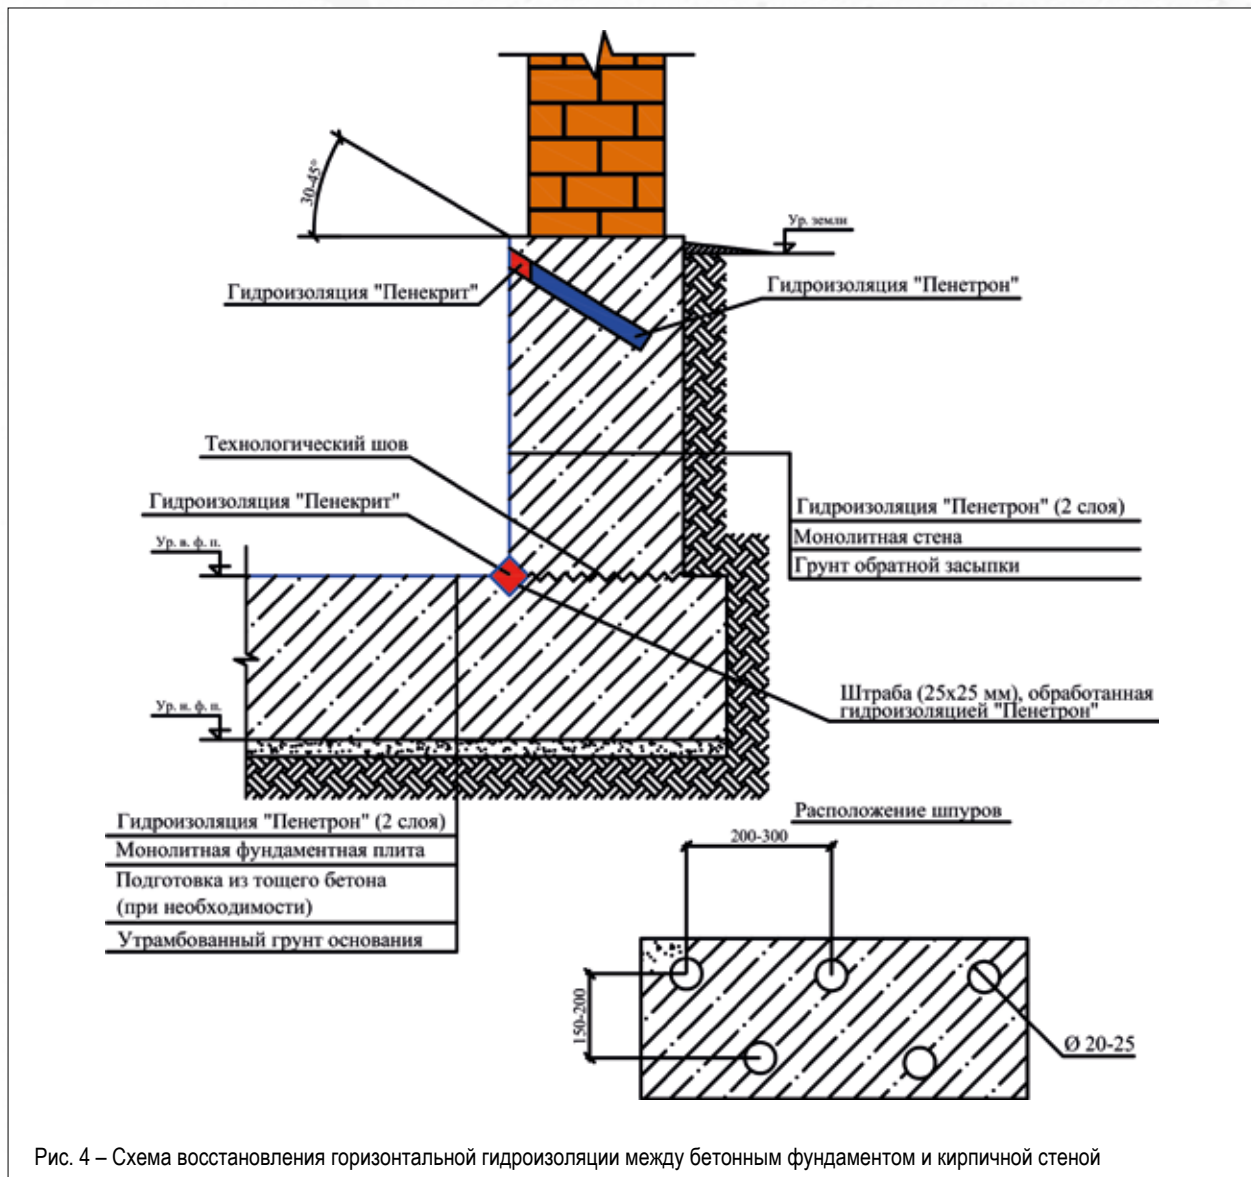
Схема восстановления горизонтальной гидроизоляции между бетонным фундаментом и кирпичной стеной
